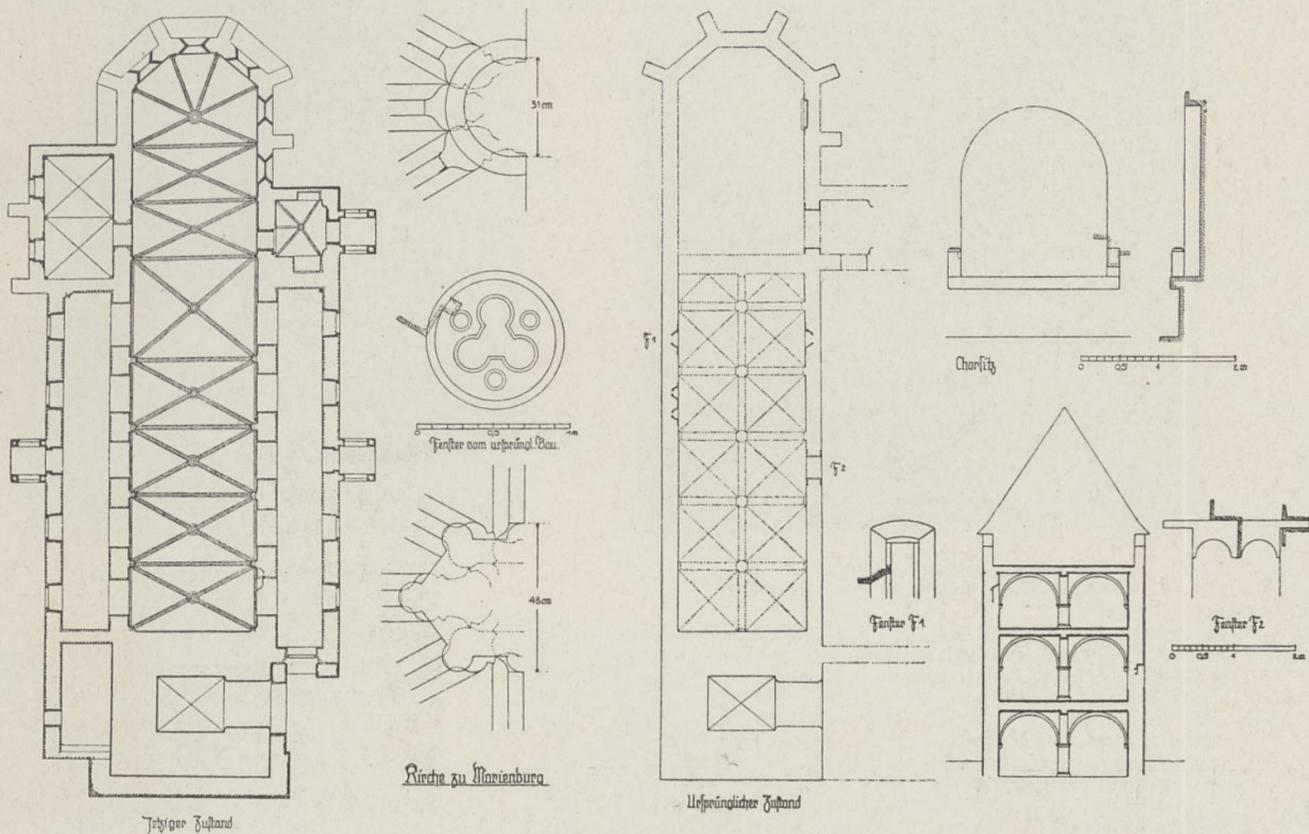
Kirche in Marienburg, Grundrisse vom jetzigen und ursprünglichen Zustande sowie Wiederherstellung des vermutlich ursprünglichen Querschnittes. M. 1:400. (Das im Grundriß unmittelbar unter F 1 liegende Fenster ist angenommen.)
